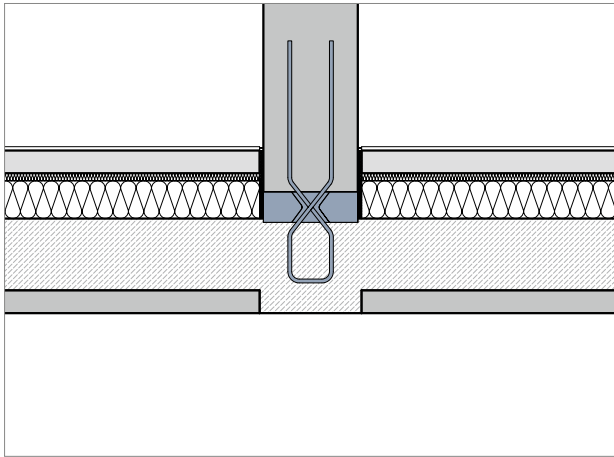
Schematische Darstellung Schöck Sconnex® Typ W bei Halbfertigteildecken und Aufdeckendämmung
